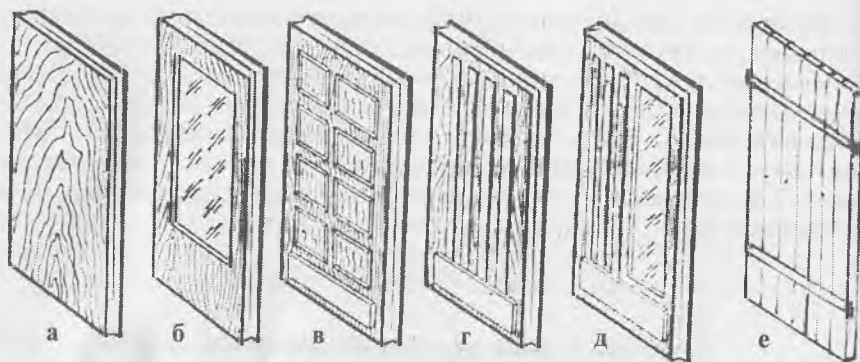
Дверные полотна внутренних (а-в) и наружных (г-е) дверей и остекленными (рис. 144, а-е). Щитовые дверные полотна представляют собой щит со сплошным заполнением или пустотелый. На торцовые кромки щита наклеивают обкладки, которые соединяют с кромками в паз и гребень.
